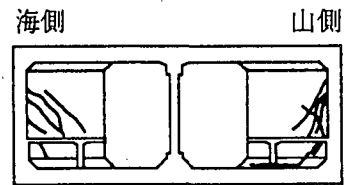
妻壁のひび割れ状況(高速長田側)
